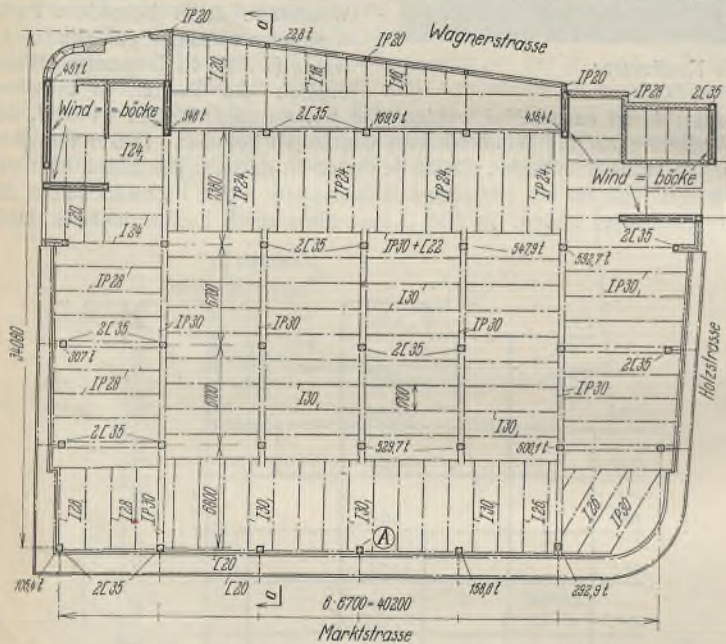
Erdgeschoß-Grundriß und Trägerlagen.
